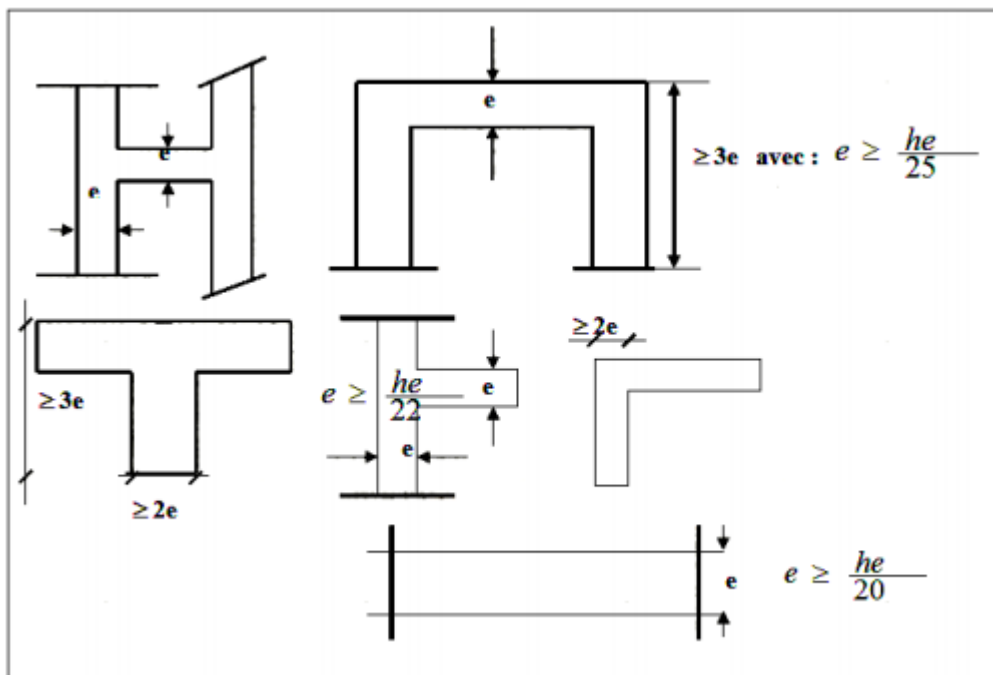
Coupes de voiles en plan (RPA 99 V 2003)
